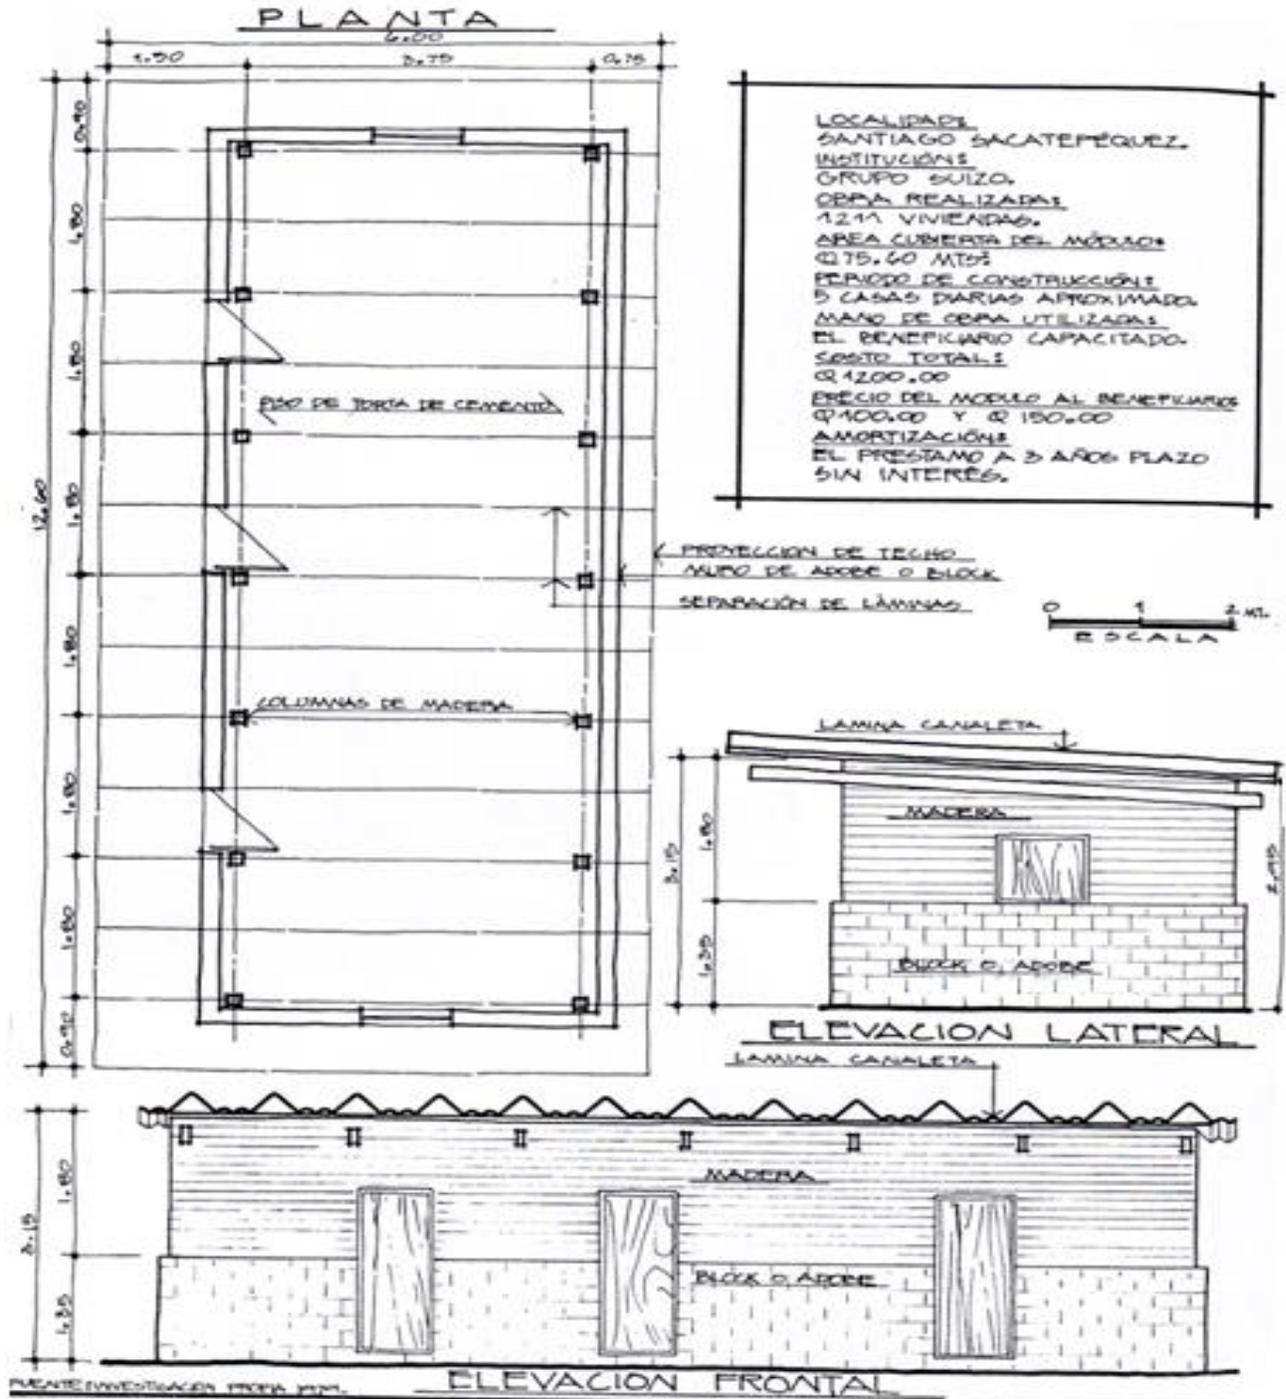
Imagen de Vivienda de madera Planta y Elevación.
